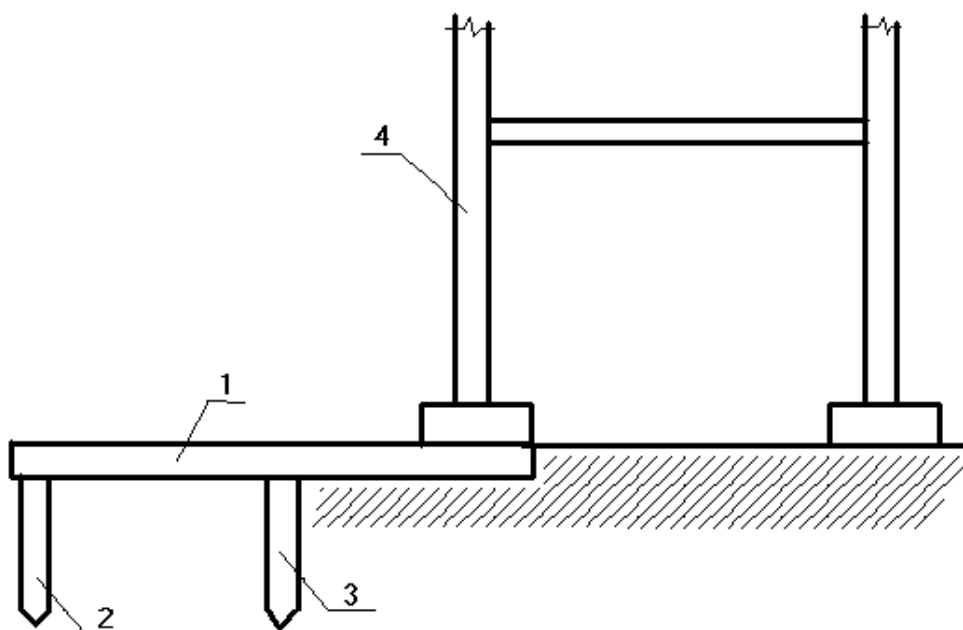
Схема усиления фундамента с помощью консоли и свай.
